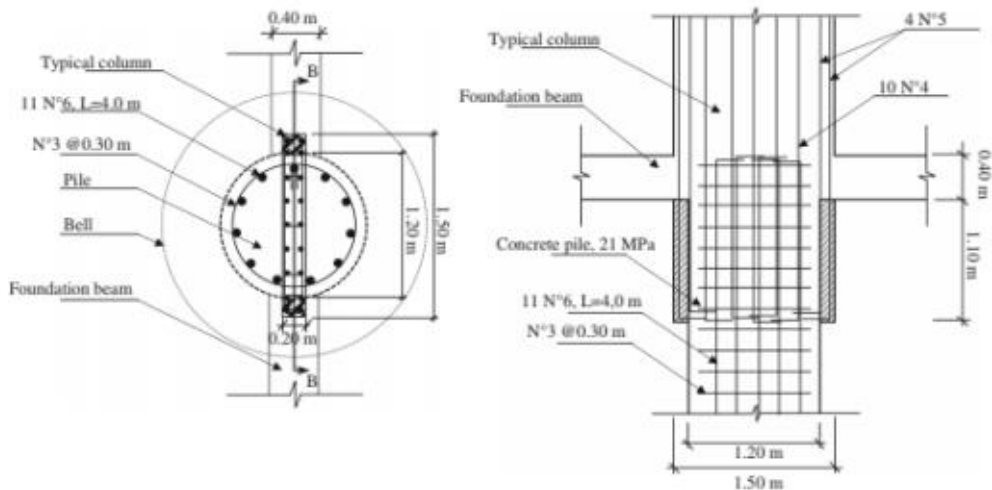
Plano estructural de las pilas usadas en la torre 6 edificio Space.
